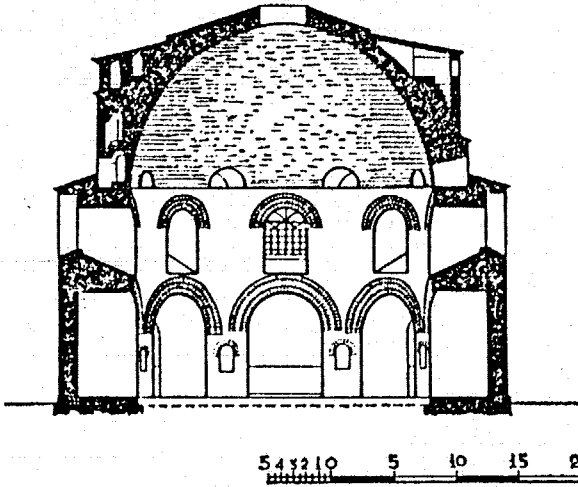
：ロトンダ・ガレリウス帝時代の断面図 (after Pazara)
